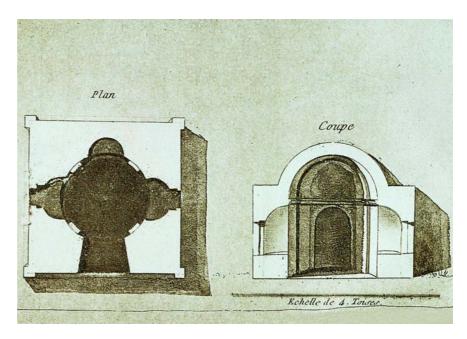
Pianta e sezione dell'edicola funeraria di Leucatia, secondo Jean Houel.
